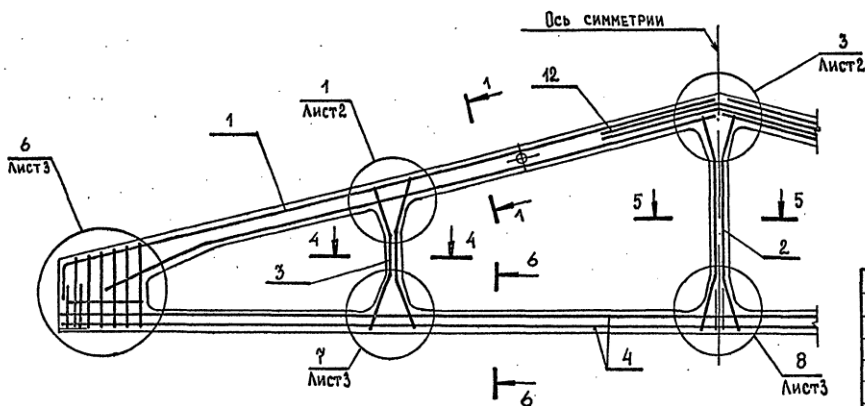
Армирование ферм 1ФТ9-2АIII...1ФТ9-6АIII
